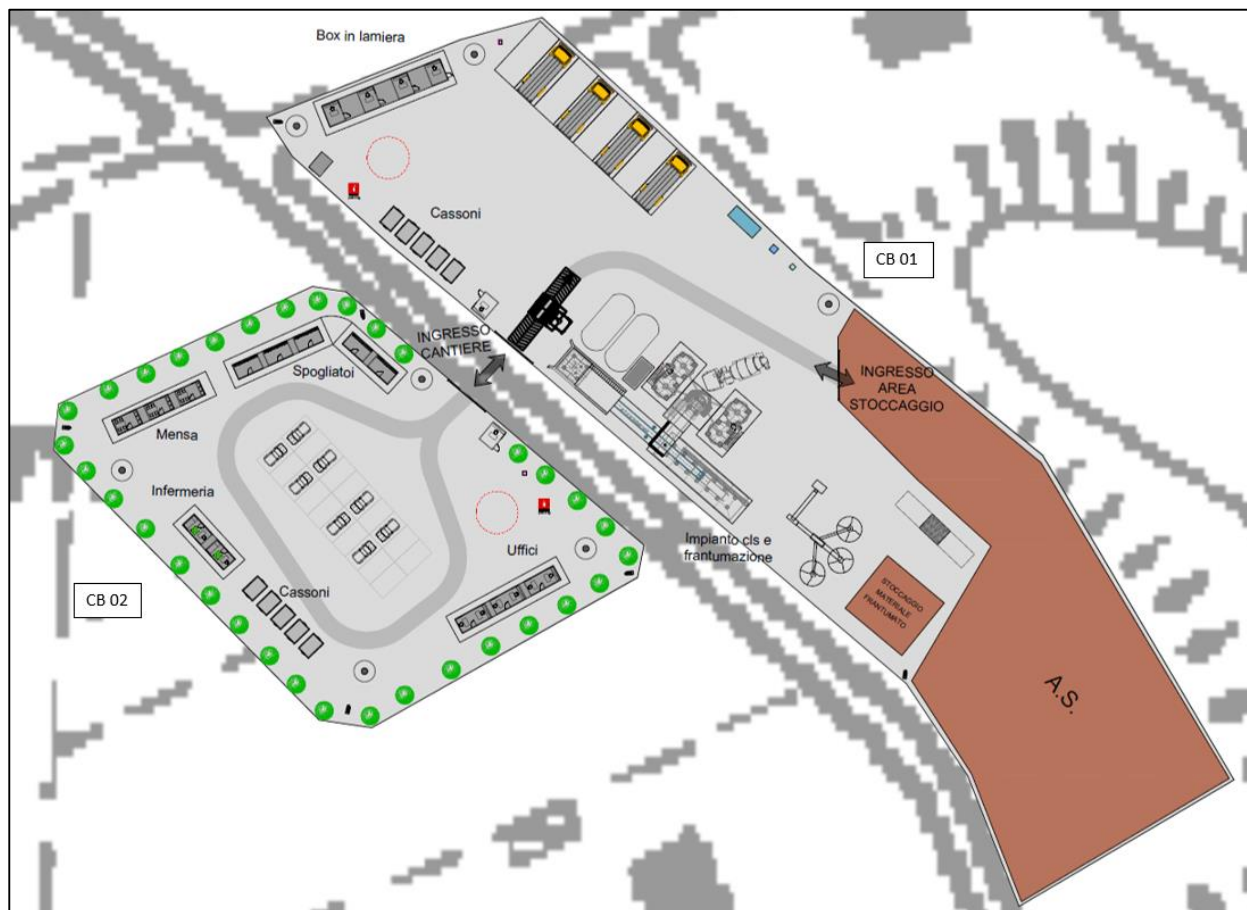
Layout cantieri base CB 01 e CB 02.
